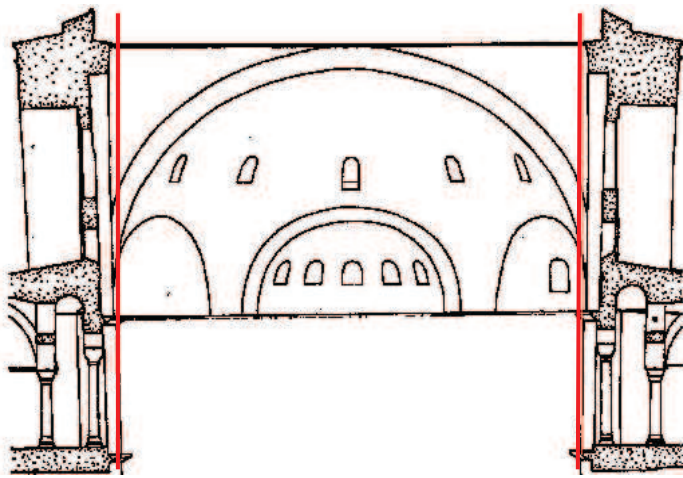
Sección transversal de la nave central de Santa Sofía en la que se aprecia la deformación que ha experimentado. (Mainstone-Van Nice).
